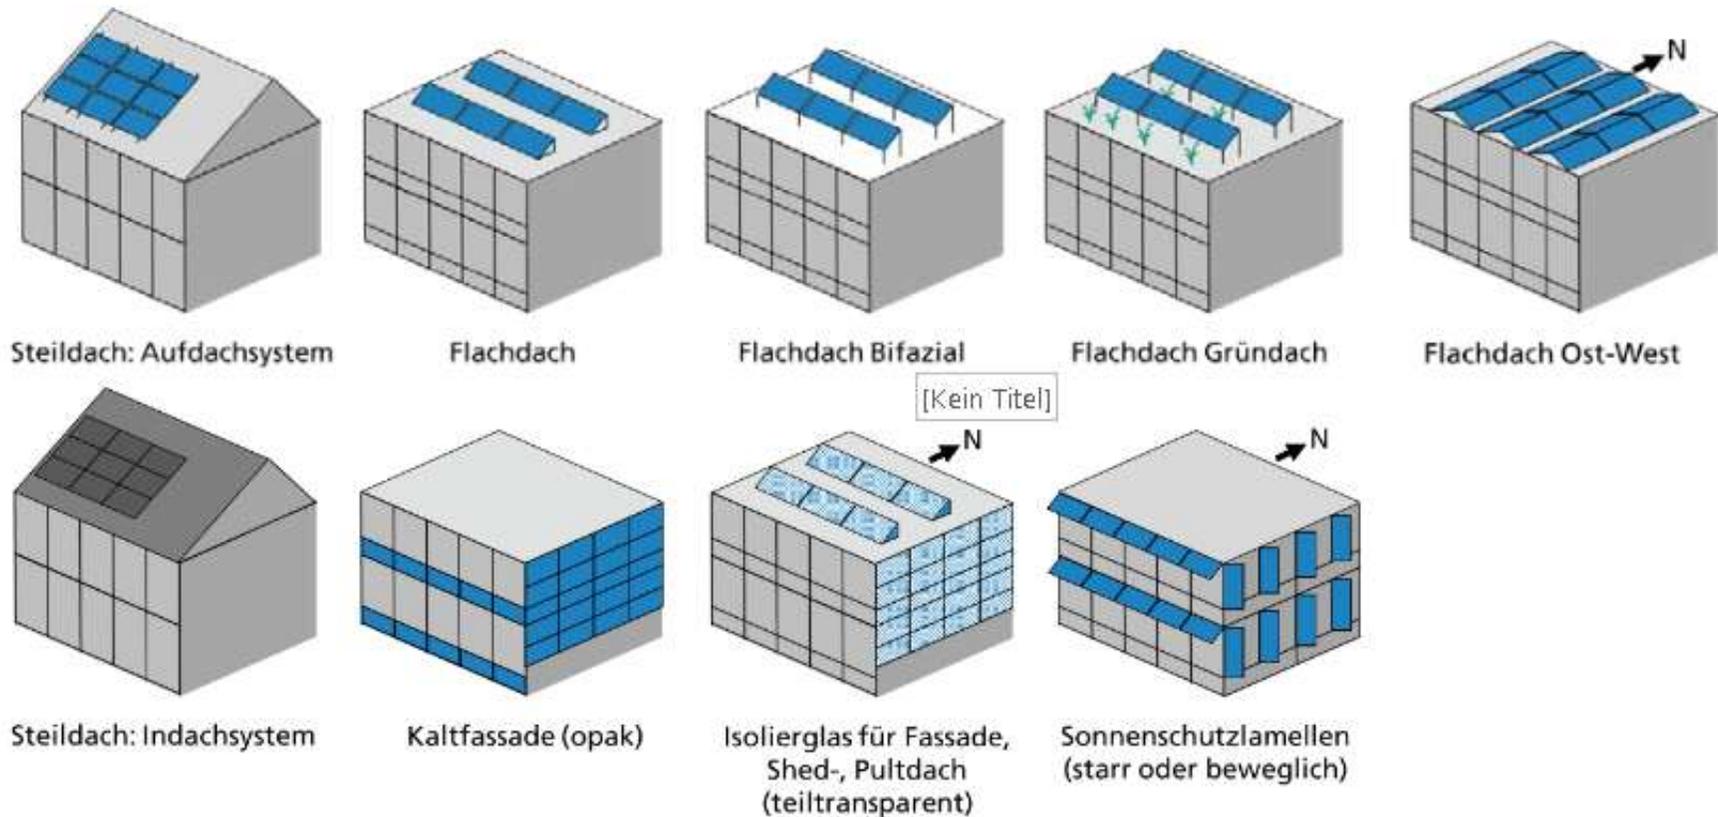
PV-Lösungen für Dach und Fassade (oben: Aufdachsysteme, unten: Integrierte PV).
